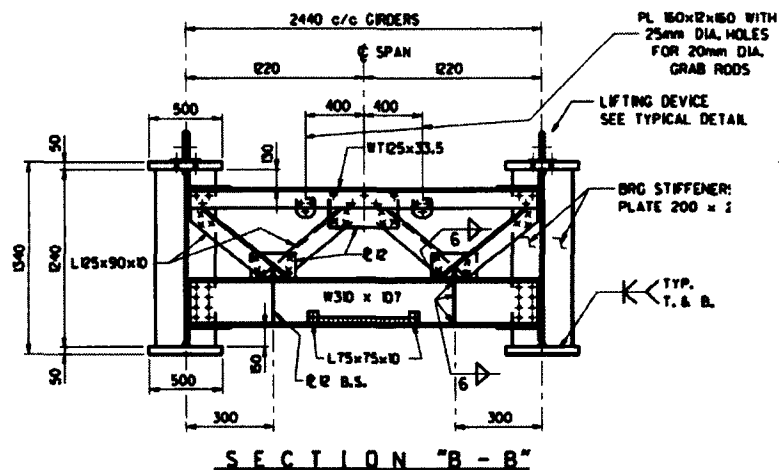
Section transversale d'un pont bi-poutres de 14,18m [CN Dessin R1A-61.05]
